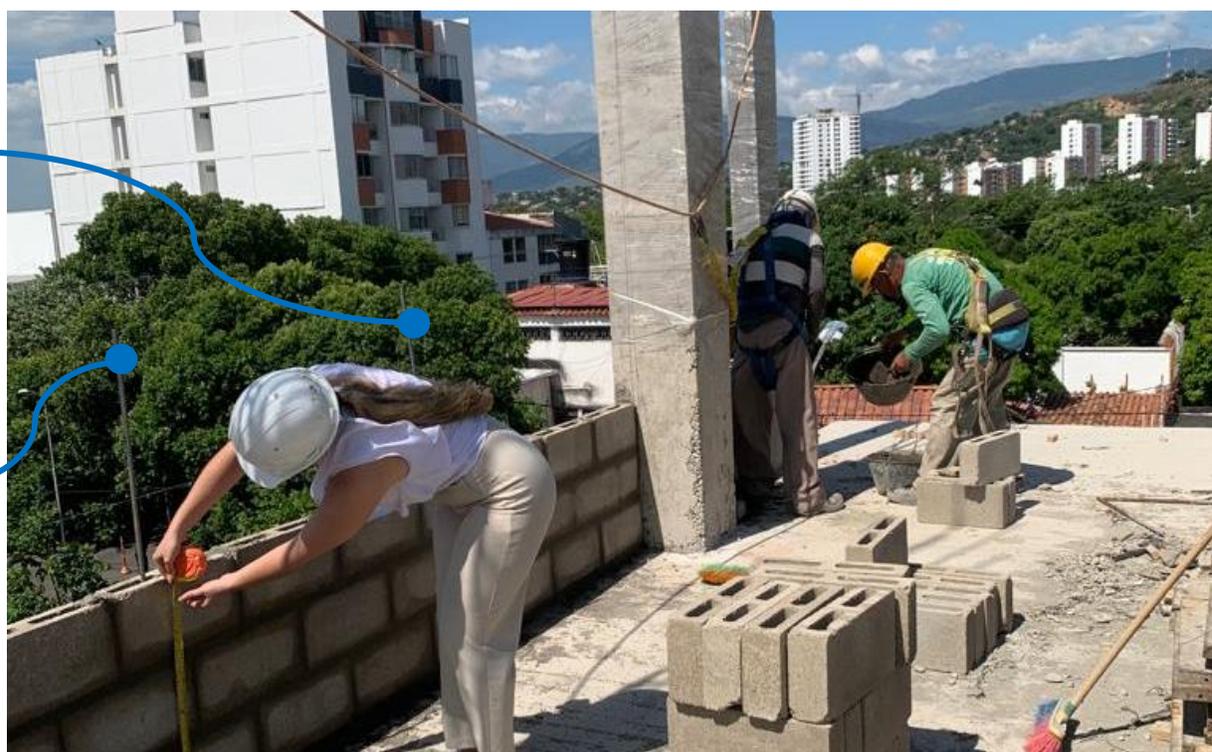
Mampostería de muros laterales eje 4 de los ejes A-C Edificio Wiedii
